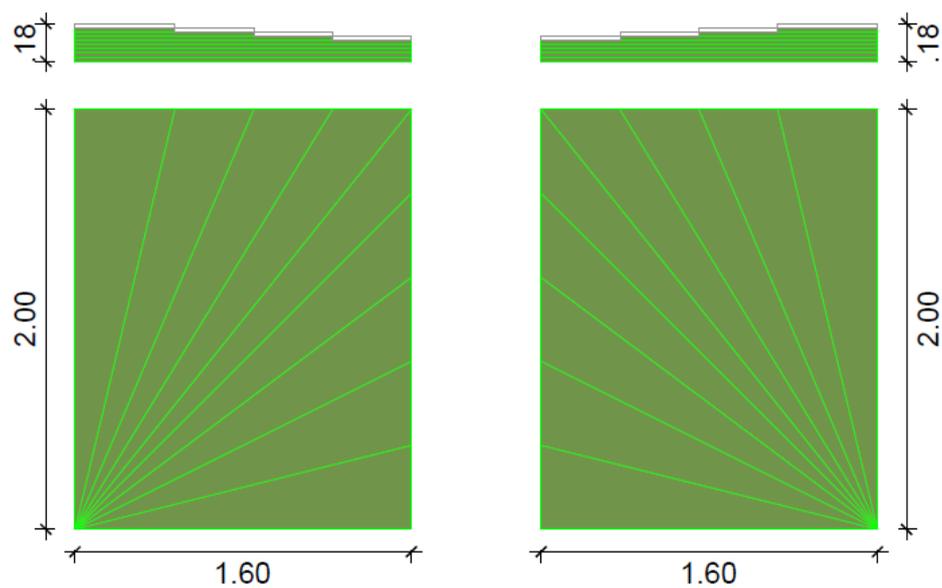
Vista frontal revestimiento puerta en abanico con plancha galvanizada
